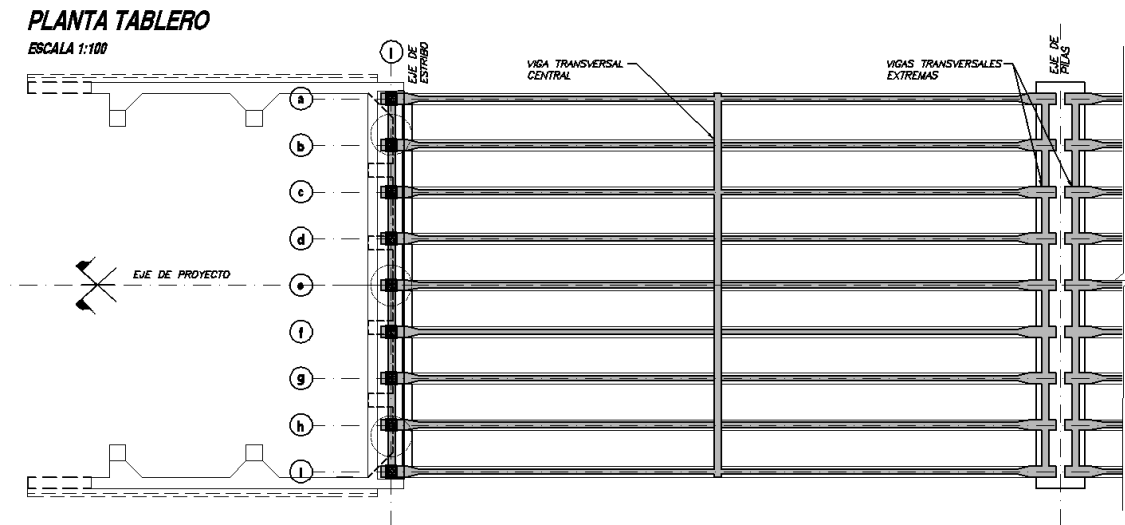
Emparrillado formado por las vigas principales y vigas transversales.
